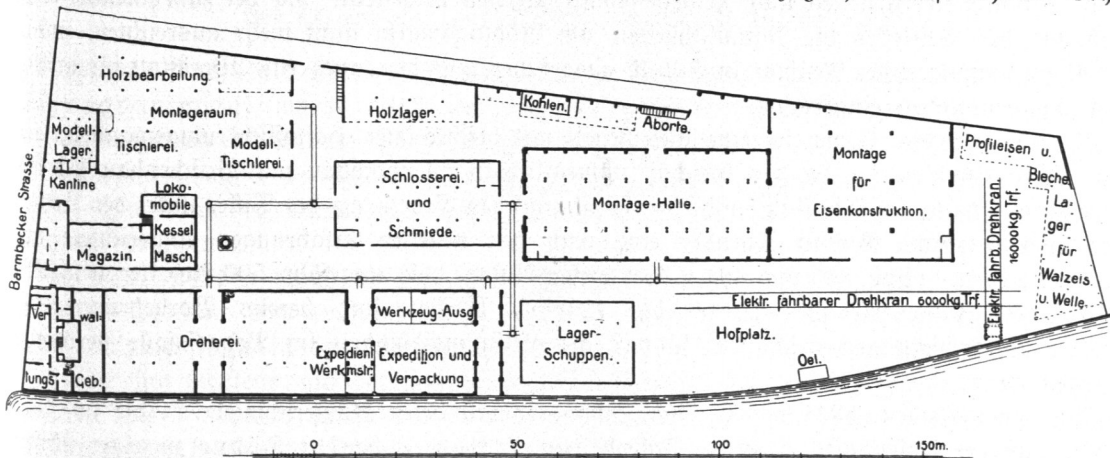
Eisenwerk vorm. Nagel & Kaemp) A.-G., Lageplan.
